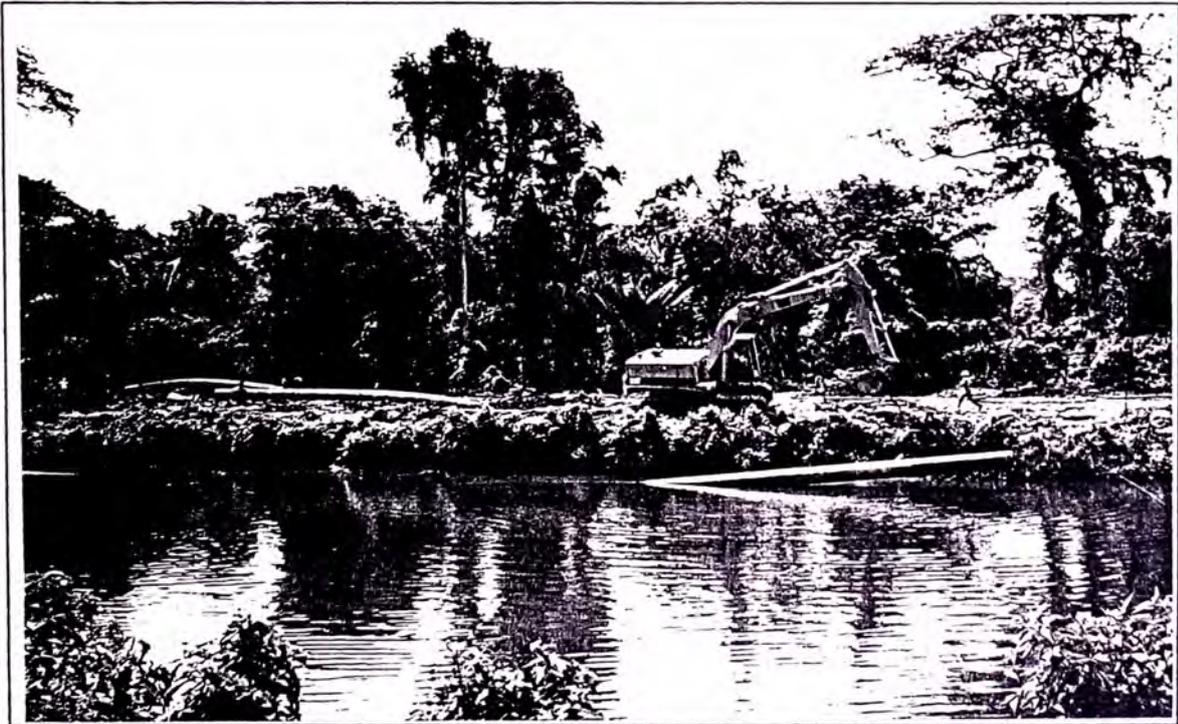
Halado de Varillón en margen izquierda hacia la Válvula.
